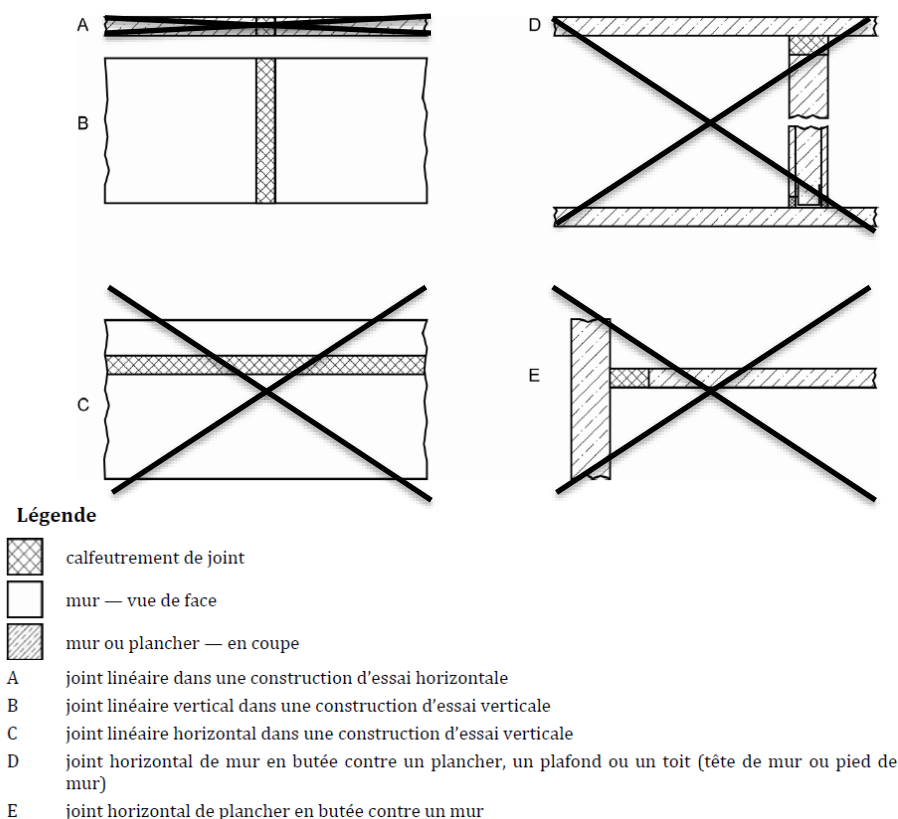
Orientation d'essai et d'application de calfeutrements de joints
